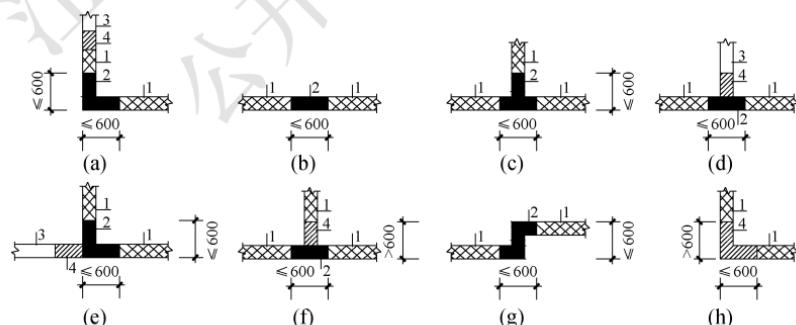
预制剪力墙板间计入预制混凝土体积的现浇段示意图
